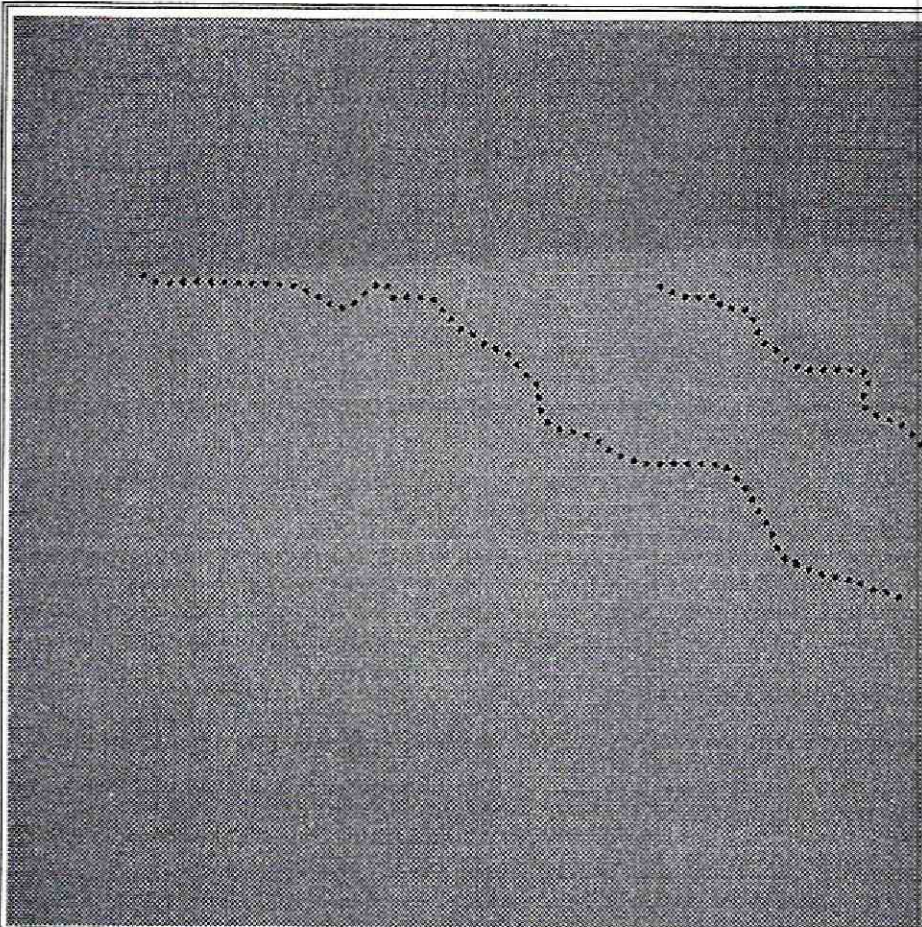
Fisuras tendencia escalonada habitación segundo nivel de la vivienda
